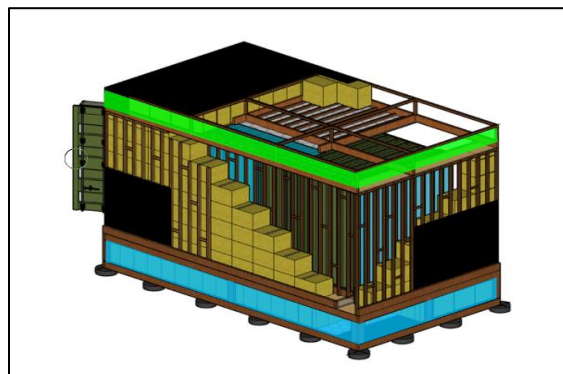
Vue en trois dimensions des surfaces où rajouter des tasseaux
